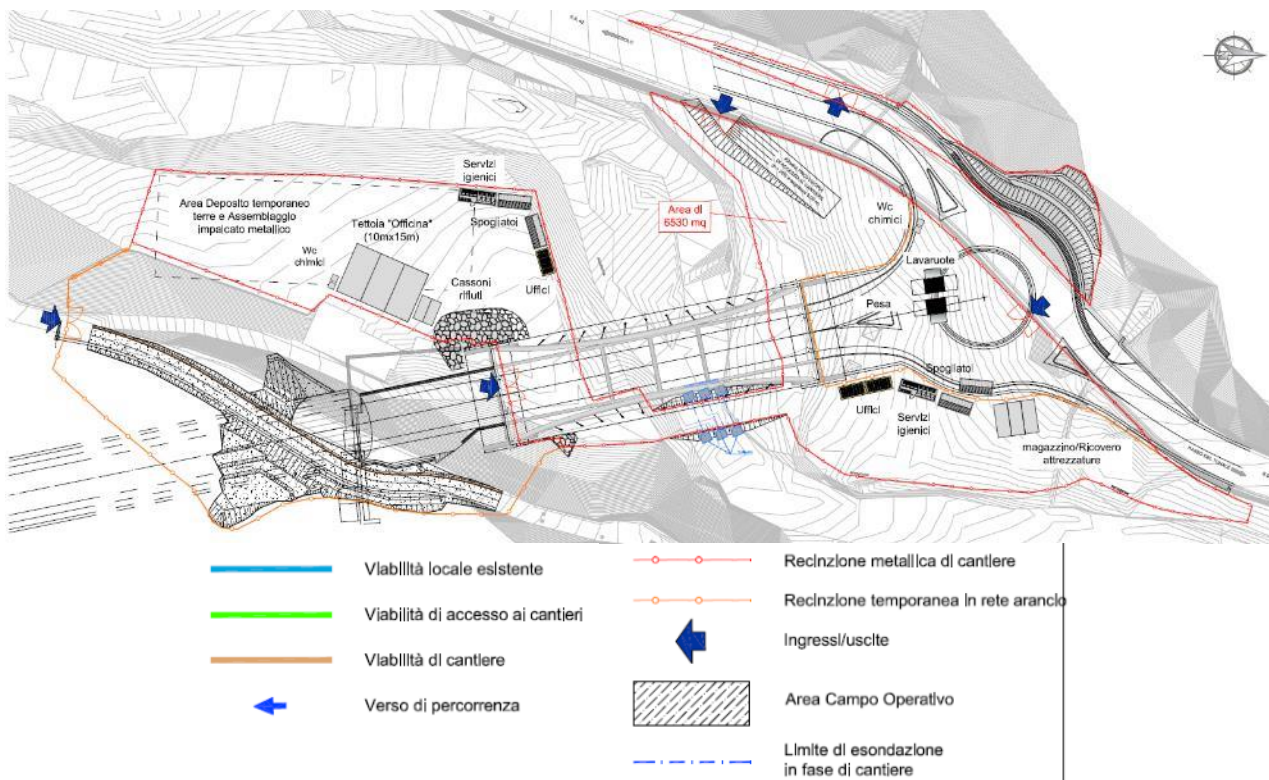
Localizzazione e layout del Cantiere Operativo Nord (fonte: V01CA00CANPL01_B e V01CA00CANSC01_B)
